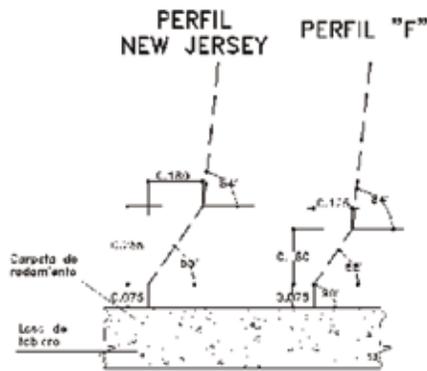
Perfiles típicos de las barandas de hormigón armado
